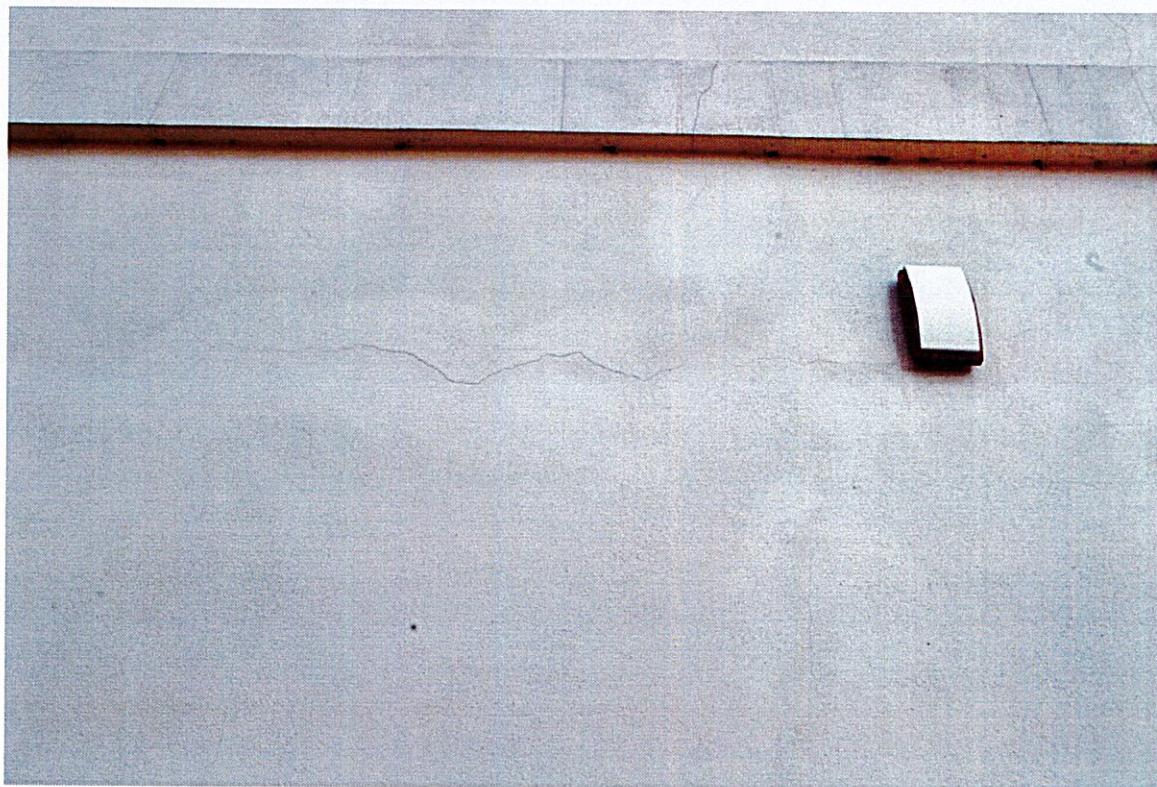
Doraźnie naprawiane i zamalowywane rysy konstrukcyjne i skurczowe na elewacji zachodniej.
